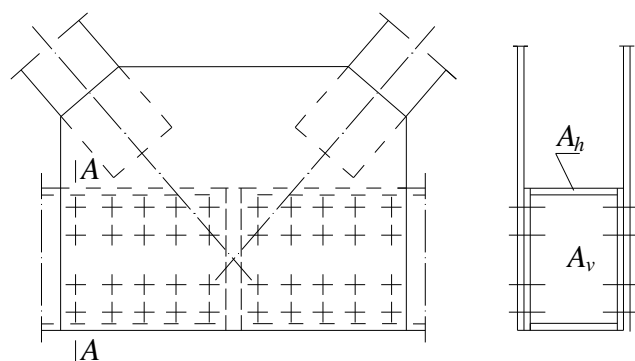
Расположение проверяемого на выносливость расчетного сечения А – А по основному металлу в сечении брутто по первому ряду высокопрочных болтов в прикреплении к узлу или в стыке двухстенчатых элементов с односторонними накладками
